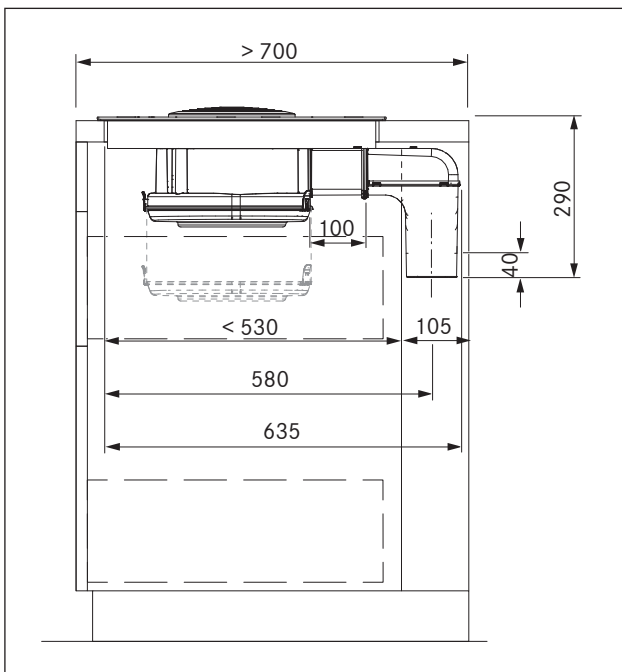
Dimensiones de montaje en extracción, profundidad de la encimera superior desde 700 mm
